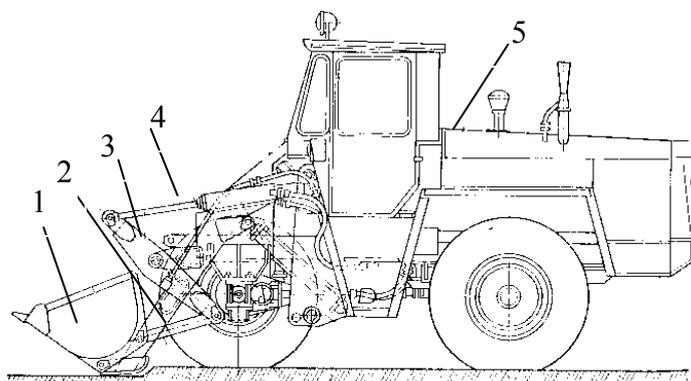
Одноковшовый погрузчик: 1 – ковш; 2 – стрела; 3 – коромысло; 4 – гидроцилиндр управления ковшом; 5 – базовая машина
